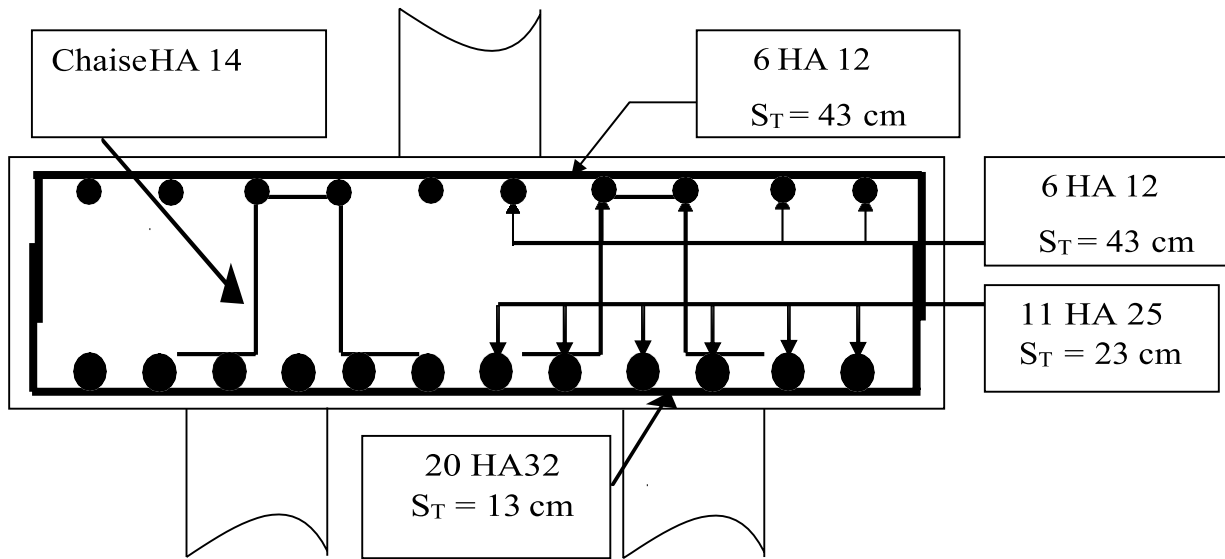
Schéma de Ferrailage de la semelle.
